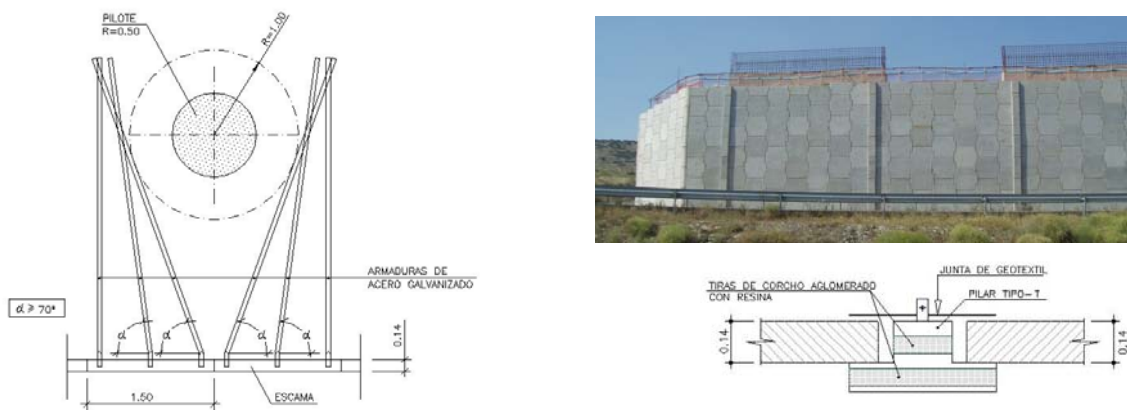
Estribos; a) Detalle de esviaje de flejes en zona de pilotes; b) Detalle de piezas especiales de corcho aglomerado
